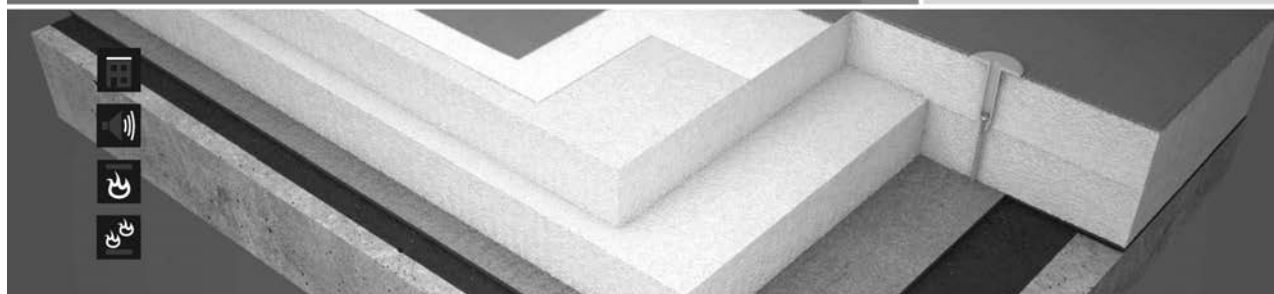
Detail ukončení hydroizolace u okapu (skladba DEKROOF 01)
